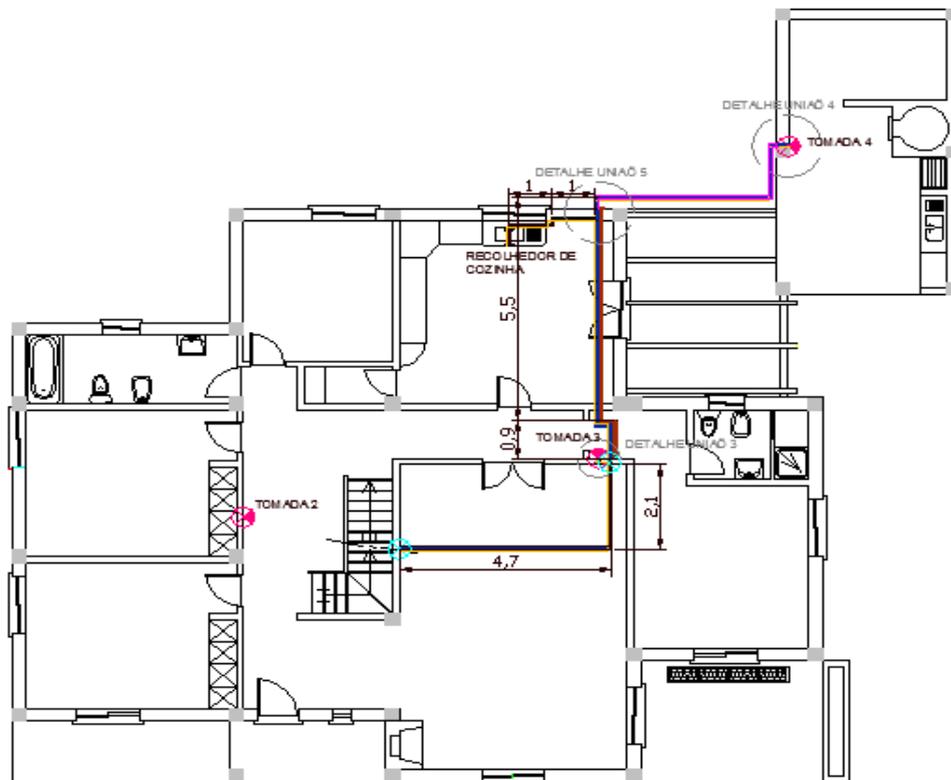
Rés-do-chão – Traçado e Dimensionamento em planta
